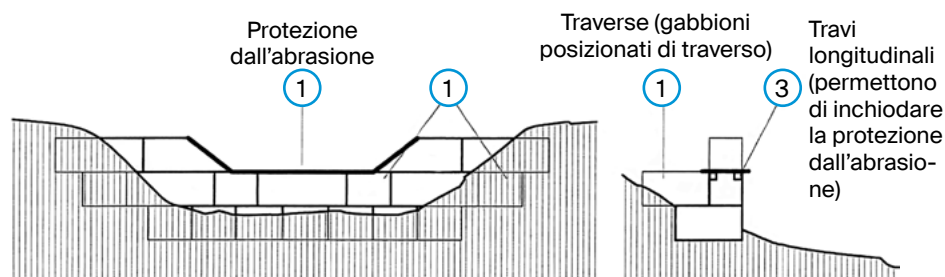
Briglia con gabbioni, variante A: prospetto e sezione (USTRA)
